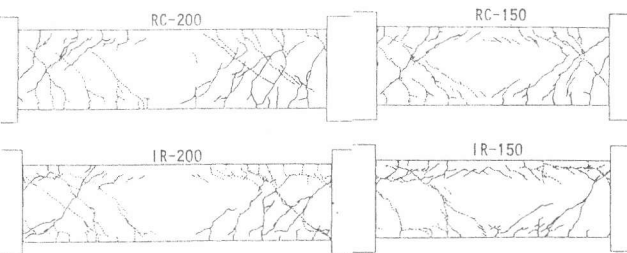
(a) ひび割れ発生状況 (δ_y)
